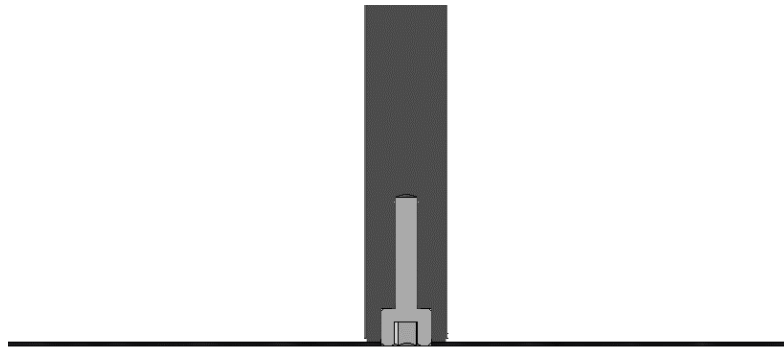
Anclajes al suelo. Fuente: Elaboración propia
